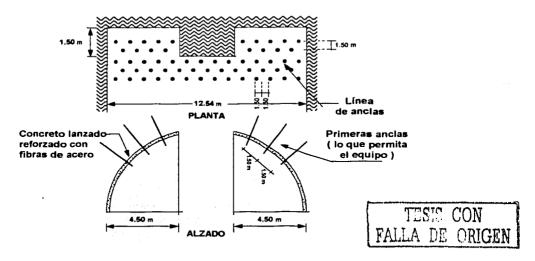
Anclaje de los laterales utilizando elementos de 6 m.
